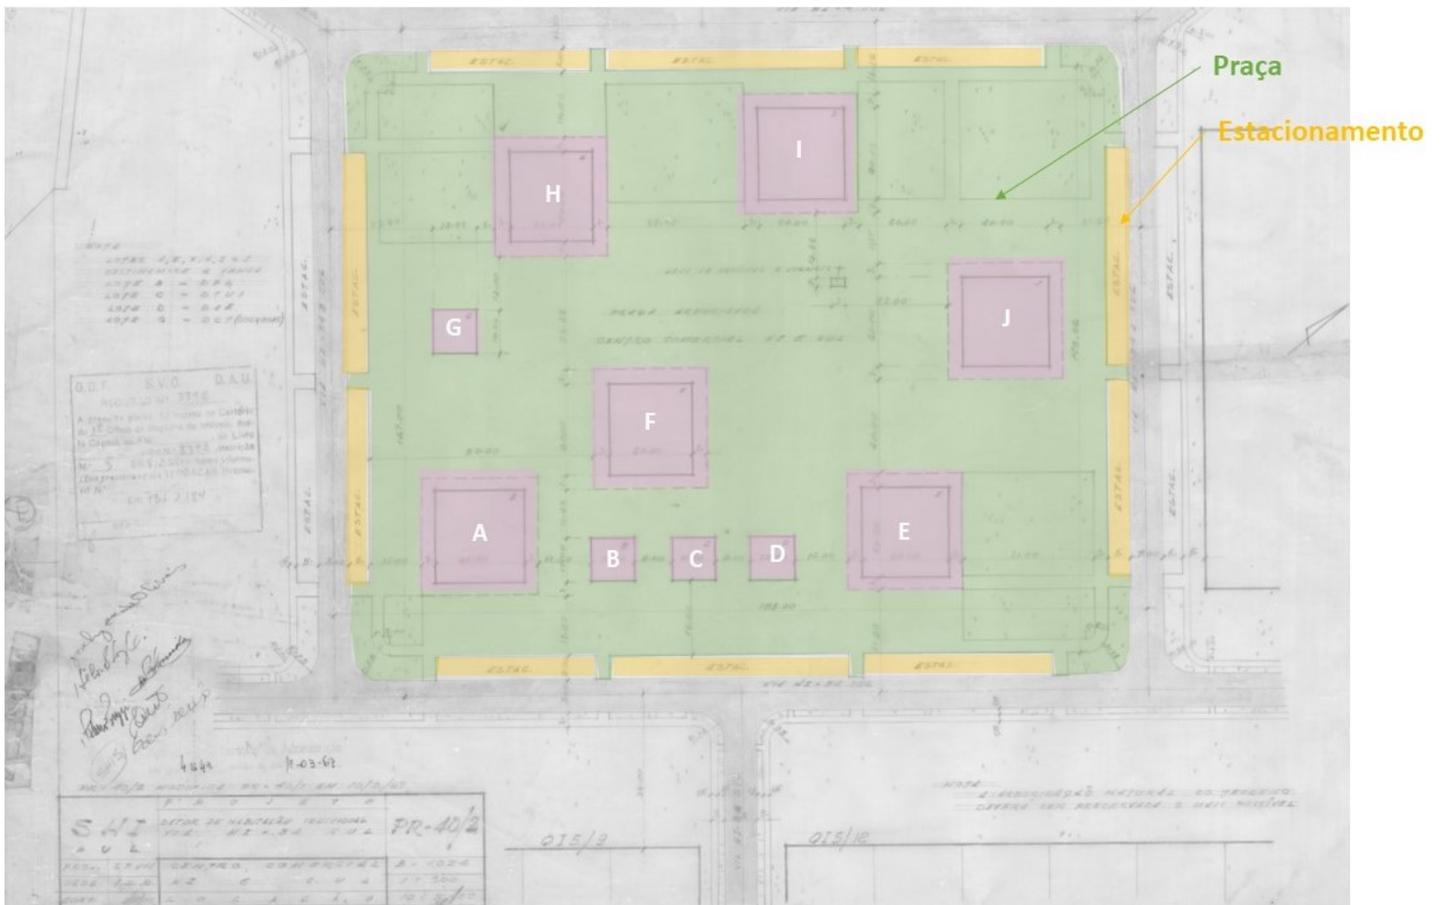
Planta registrada SHIS PR 40/2, com destaque aos elementos urbanísticos previstos.
